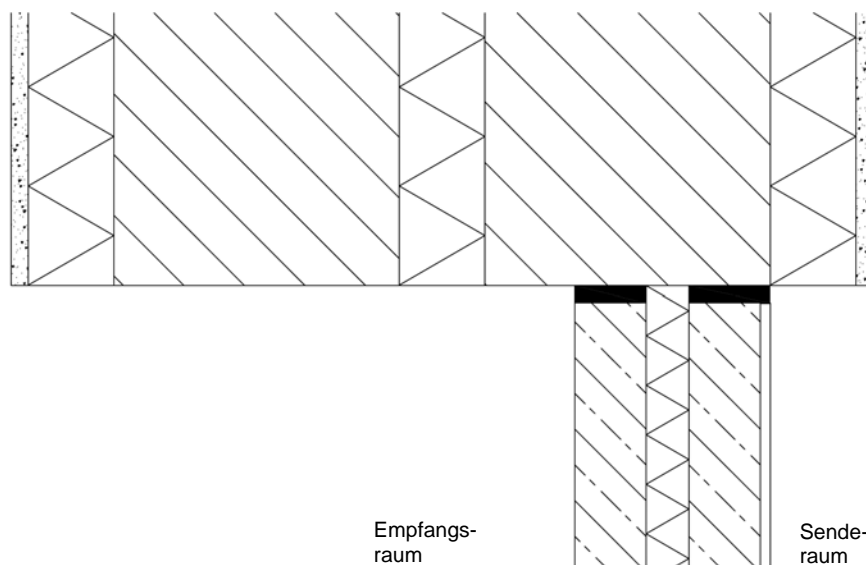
Anschlussdetail Probe 2 der Einbausituation im Prüfstand
